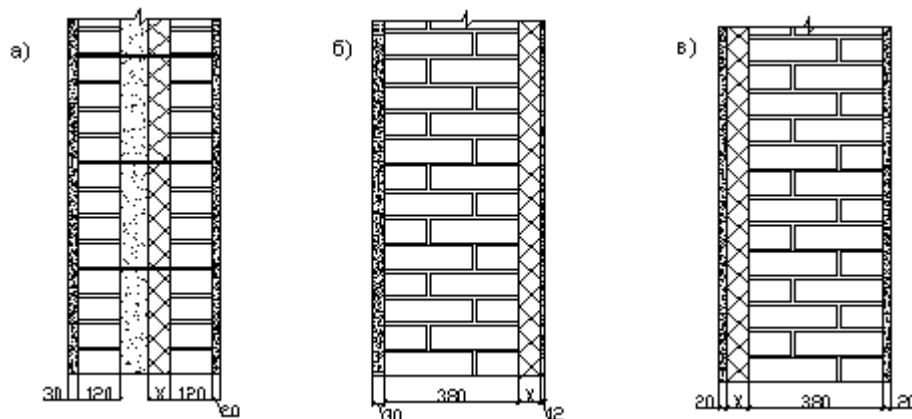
Системи утеплення: а) утеплюючий шар може розміщуватися в стіні (так звана колодязна кладка), б) утеплюючий шар розташований на внутрішній поверхні огорожуючої (зовнішньої стіни) конструкції, в) на зовнішній поверхні цієї конструкції.
